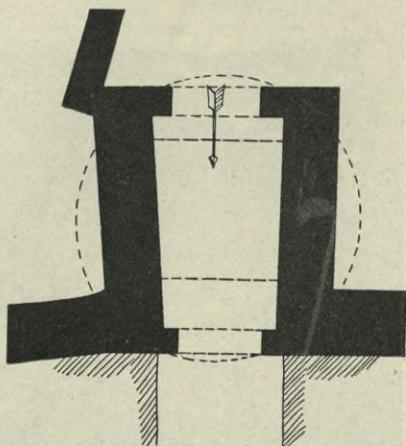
Nikolaiturm, Grundriß des Erdgeschosses.
